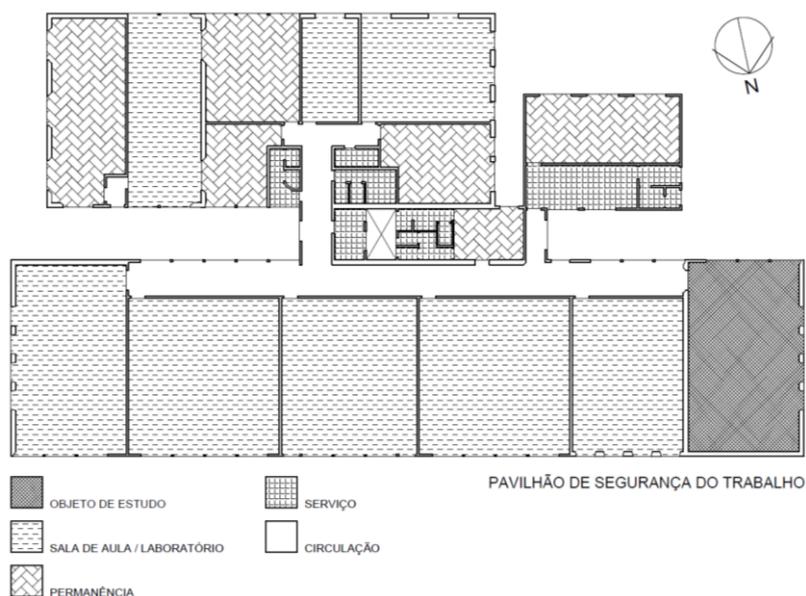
Planta baixa esquemática do Pavilhão de Segurança do Trabalho.
